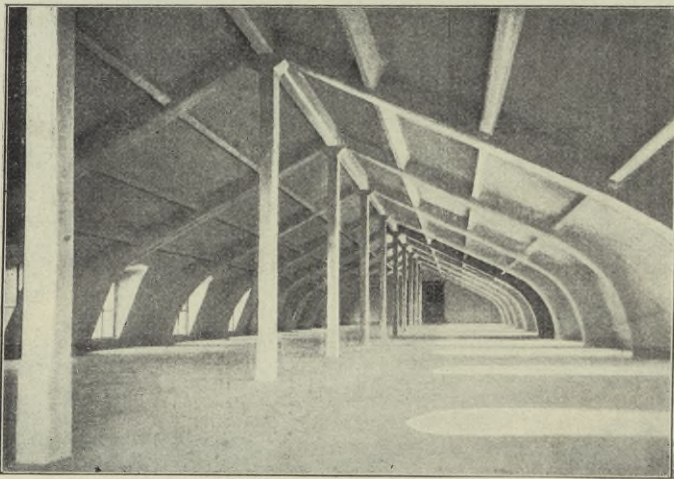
Dachgeschoß der Tabakfabrik in Bologna mit Hängesäulen
